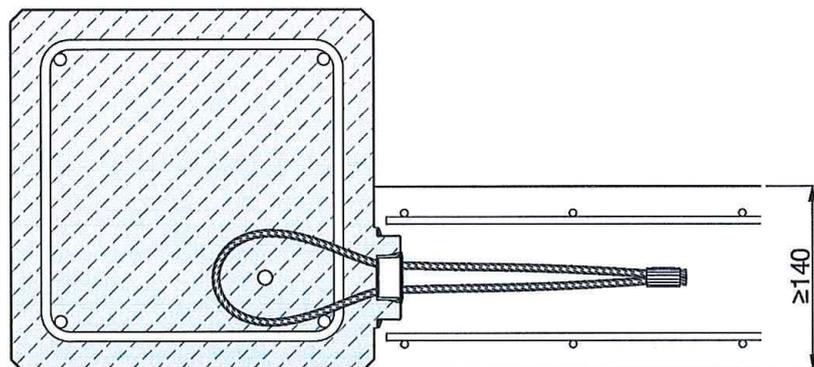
Verbindung Wand (Fertigteil) – Stütze (Ortbeton)
